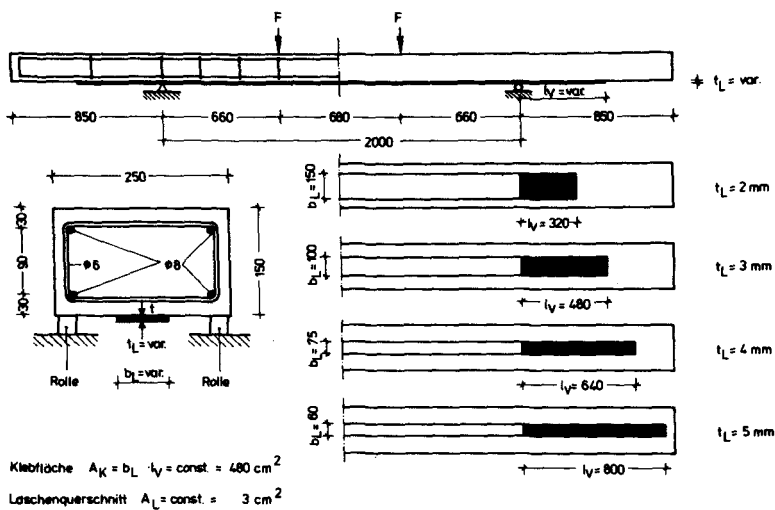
Abmessungen, Bewehrung und Belastungsanordnung der Versuchsbalken nach /33/
